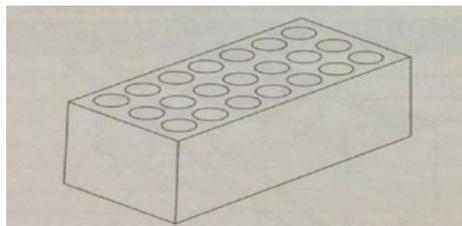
Bloco cerâmico utilizado na construção do pavilhão de Construção Civil..
